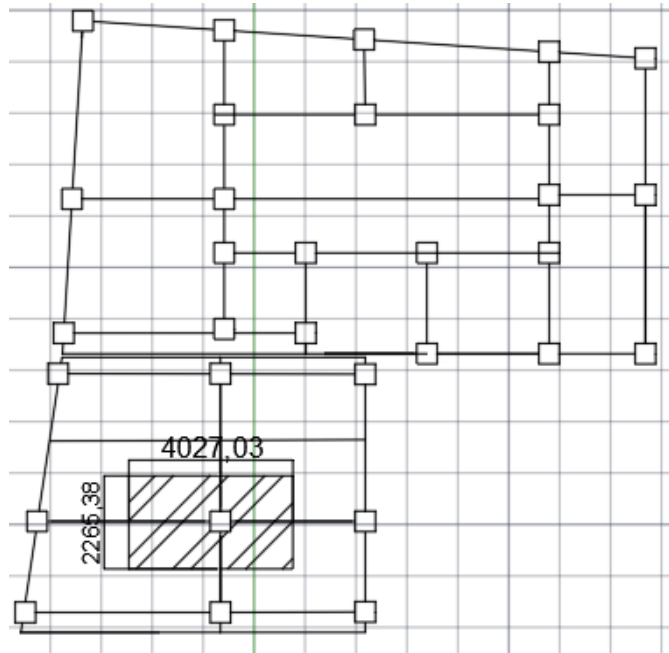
Hasil Desain Dimensi Kolom di Bangunan B
